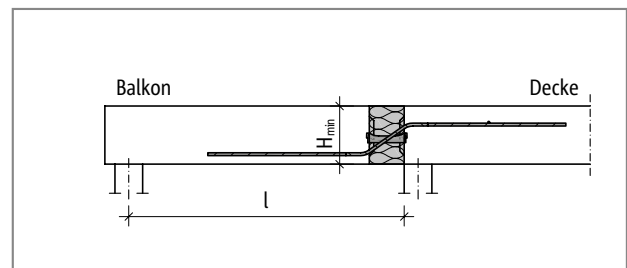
Schöck Isokorb® Typ QXT: Statisches System (Typ QXT60 bis QXT90)
